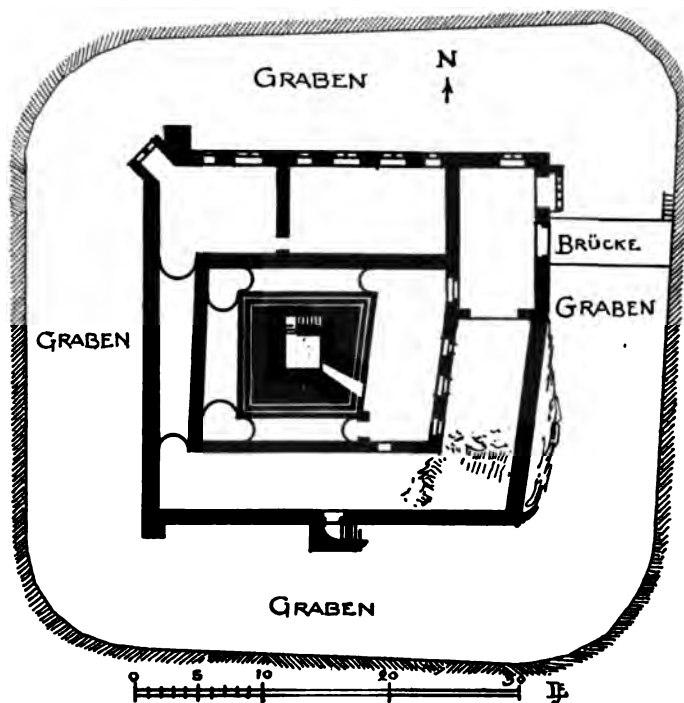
Rüdesheim. Oberburg. Grundriss. (Nach v. Cohausen.)
